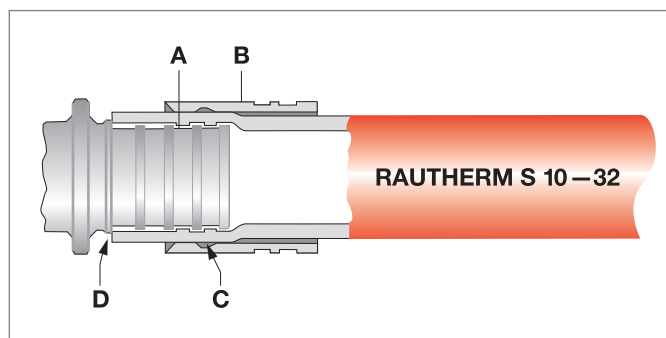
Collegamento a manicotto autobloccante con tubo di riscaldamento RAUTHERM S di dimensioni 10-32
